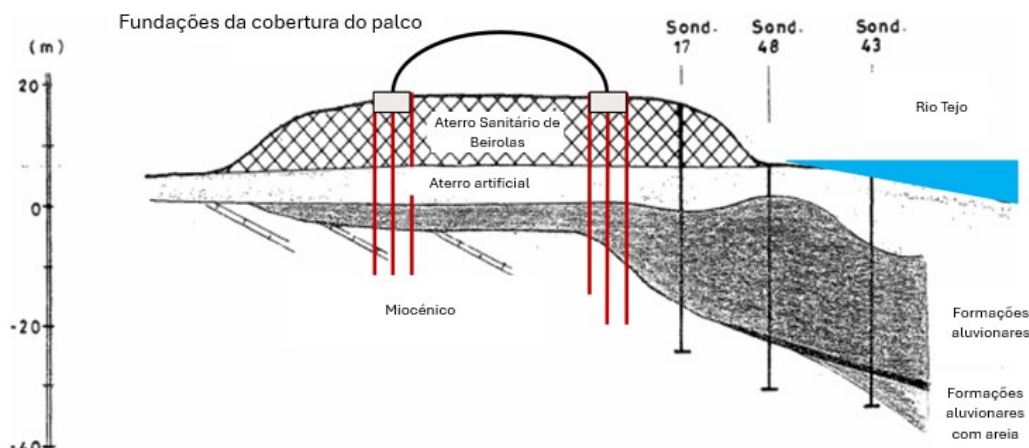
Corte esquemático, Nascente – Poente, da zona do palco.
